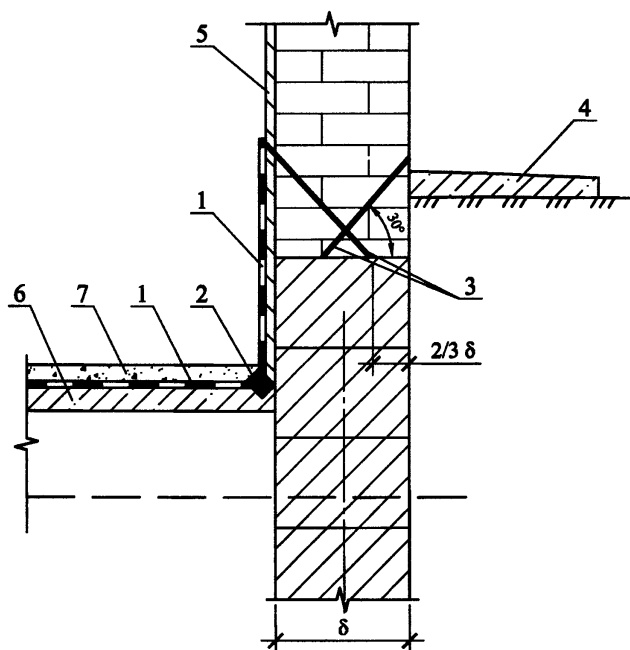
Гидроизоляция стен подвала с капиллярным подсосом грунтовых вод
